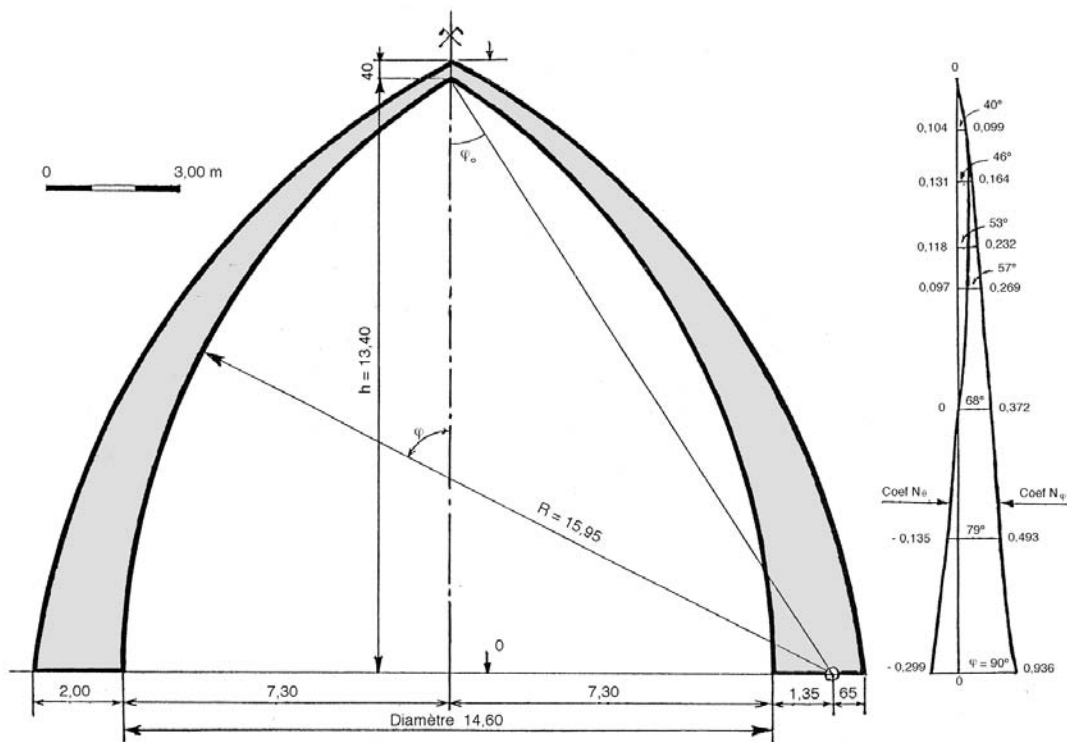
Le tombeau d'Agamemnon à Mycènes. Construction réalisée en 1400 av. J.-C. Vue en coupe Coupe – Diagramme des poussées très plat : la stabilité est parfaite.
